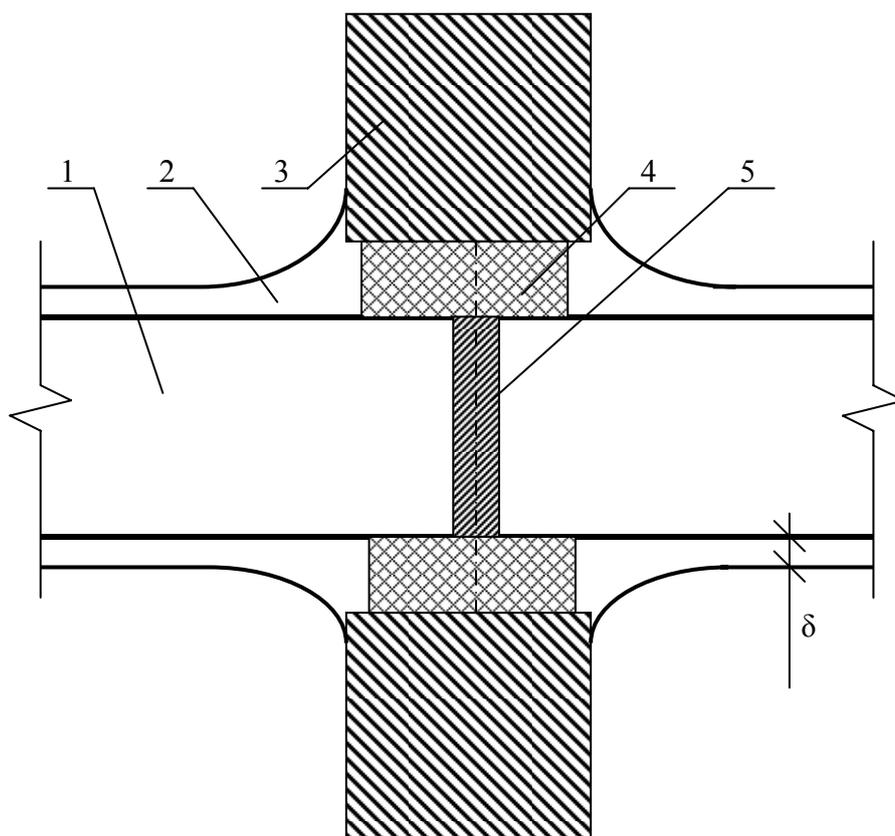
Конструкция узла пересечения ограждающей конструкции огнестойким воздуховодом
